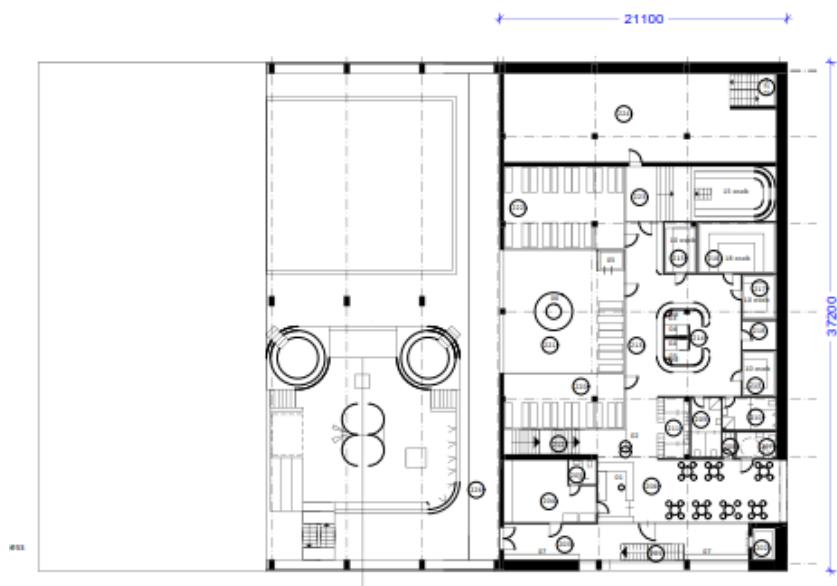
Půdorys 1.NP – 50 m bazén (zdroj: Šumavaplan projekt s.r.o.)
